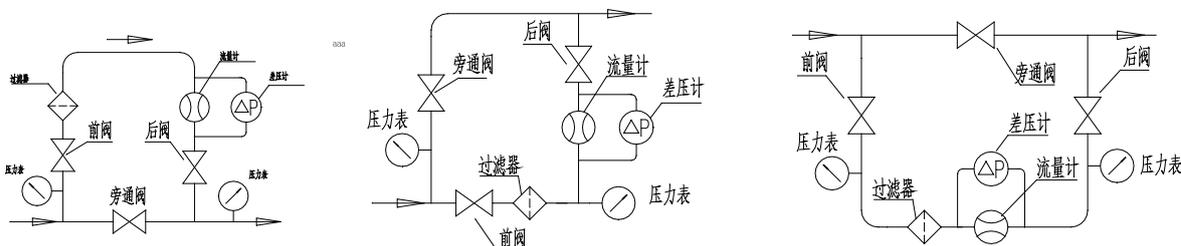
上进下出立面图（推荐）      图 7 下进上出立面图（不推荐）      图 8 左进右出平面图
